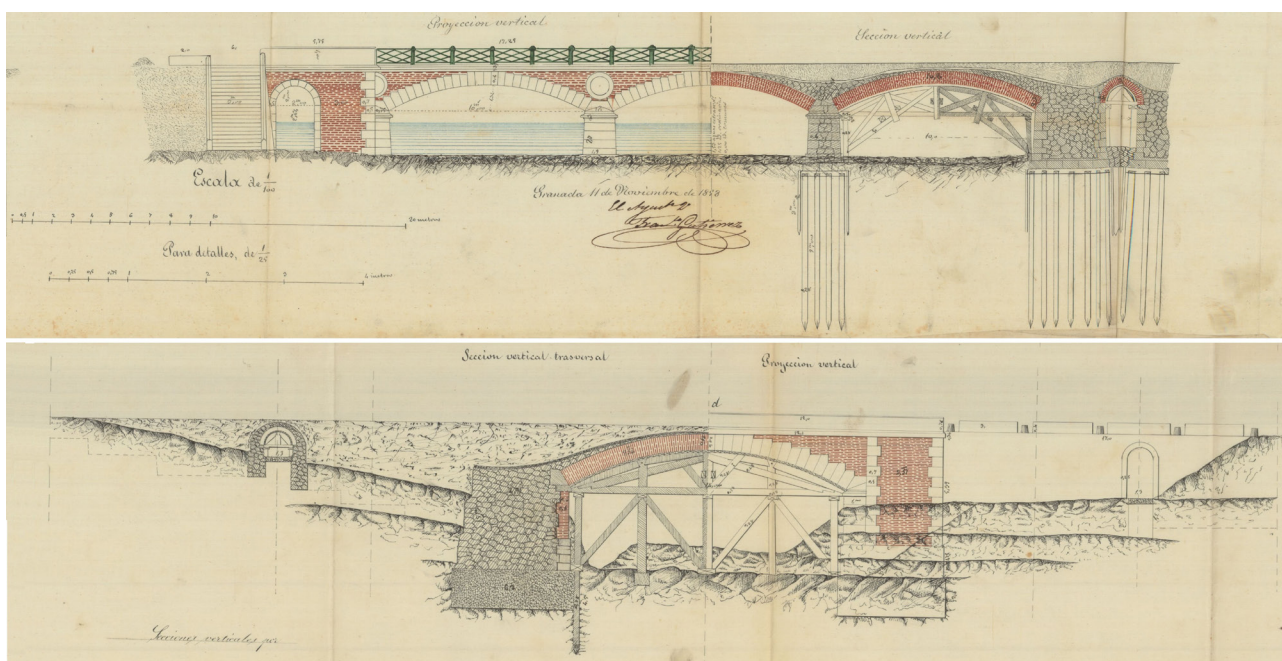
Francisco Gutiérrez. Alzado de los puentes sobre los ríos de Guadix y Gor, en la carretera de Granada a Murcia. Planos del proyecto técnico. 1855. Archivo General de la Administración. Alcalá de Henares. España. Copyright Archivo General de la Administración.
